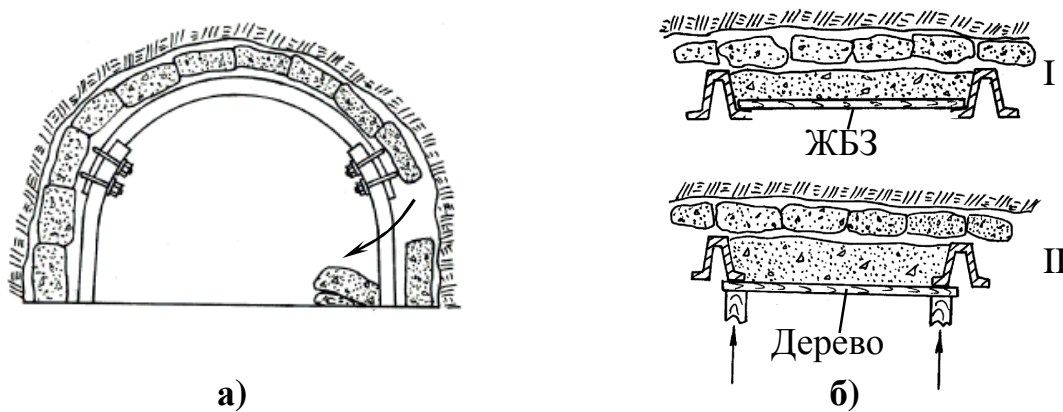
Схемы ремонта бетонной крепи горизонтальной выработки (а) и варианты возведения опалубки при обратном профиле СВП (б): I – с опалубкой из ЖБЗ; II – из досок
